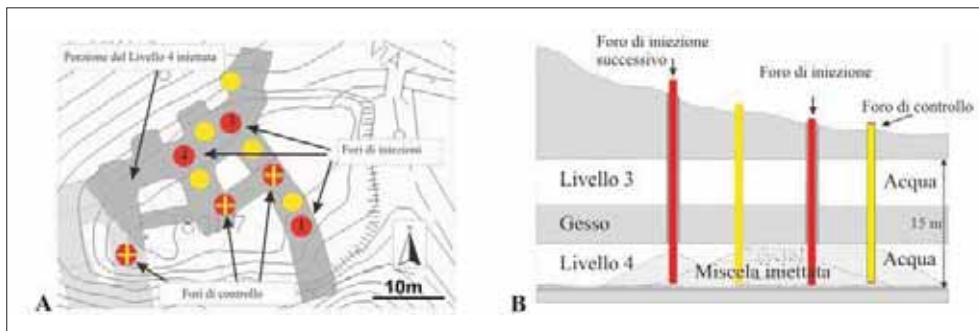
Metodologia di iniezione a) planimetria con la distribuzione dei fori di iniezione e di controllo nella parte bassa del cantiere b) sezione schematica delle operazioni di iniezione e controllo nei fori in avanzamento
